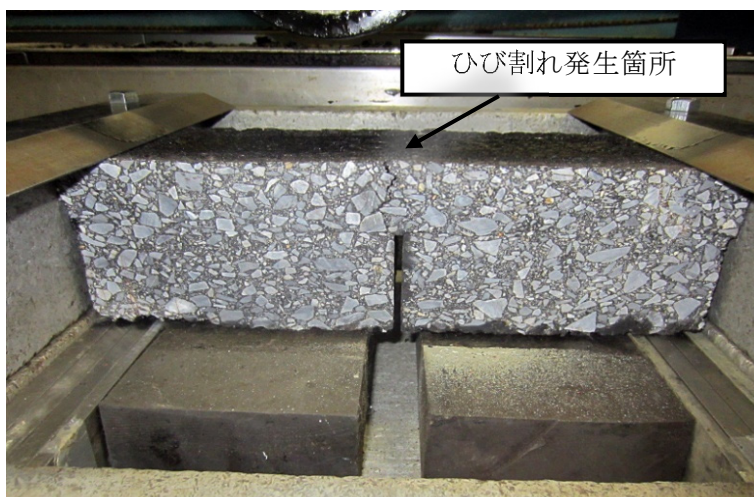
ひび割れ抵抗性評価試験でのひび割れ発生状況
